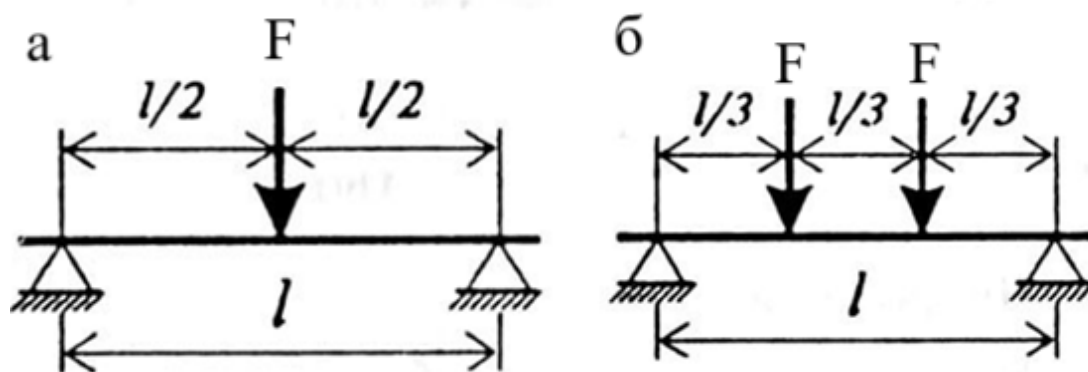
Схемы испытания строительных материалов на изгиб:
